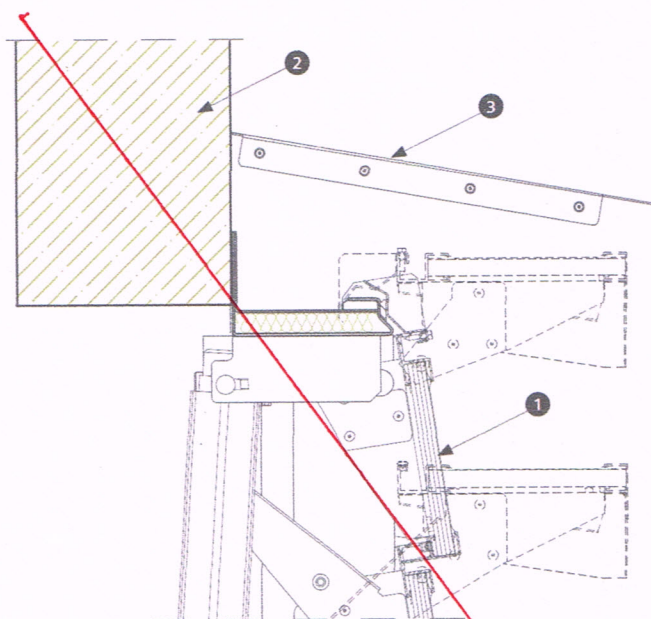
Montaż klapy żaluzyjowej w ścianie (fasadzie) do konstrukcji wsporczej
